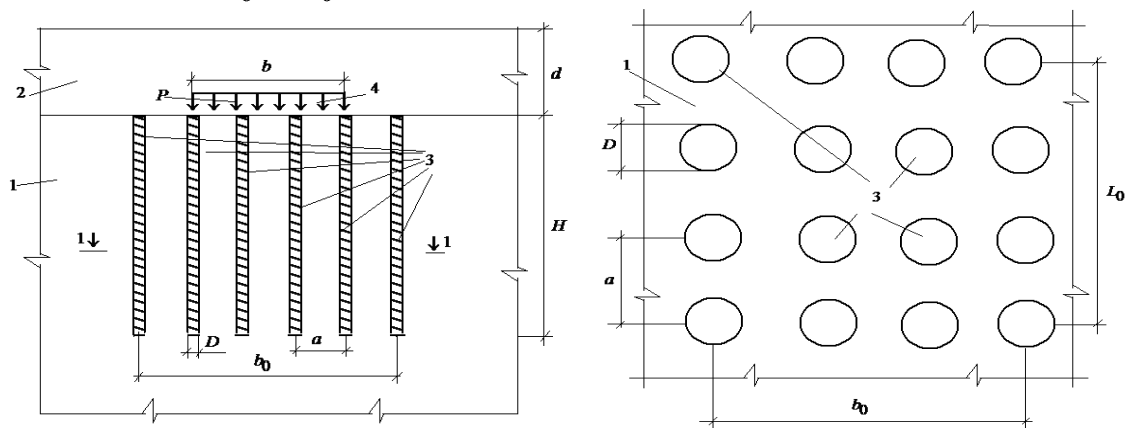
Расчетные схемы армированного основания: 1 – основание; 2 – грунт выше подошвы фундамента; 3 – армирующие элементы; 4 – нагрузка
